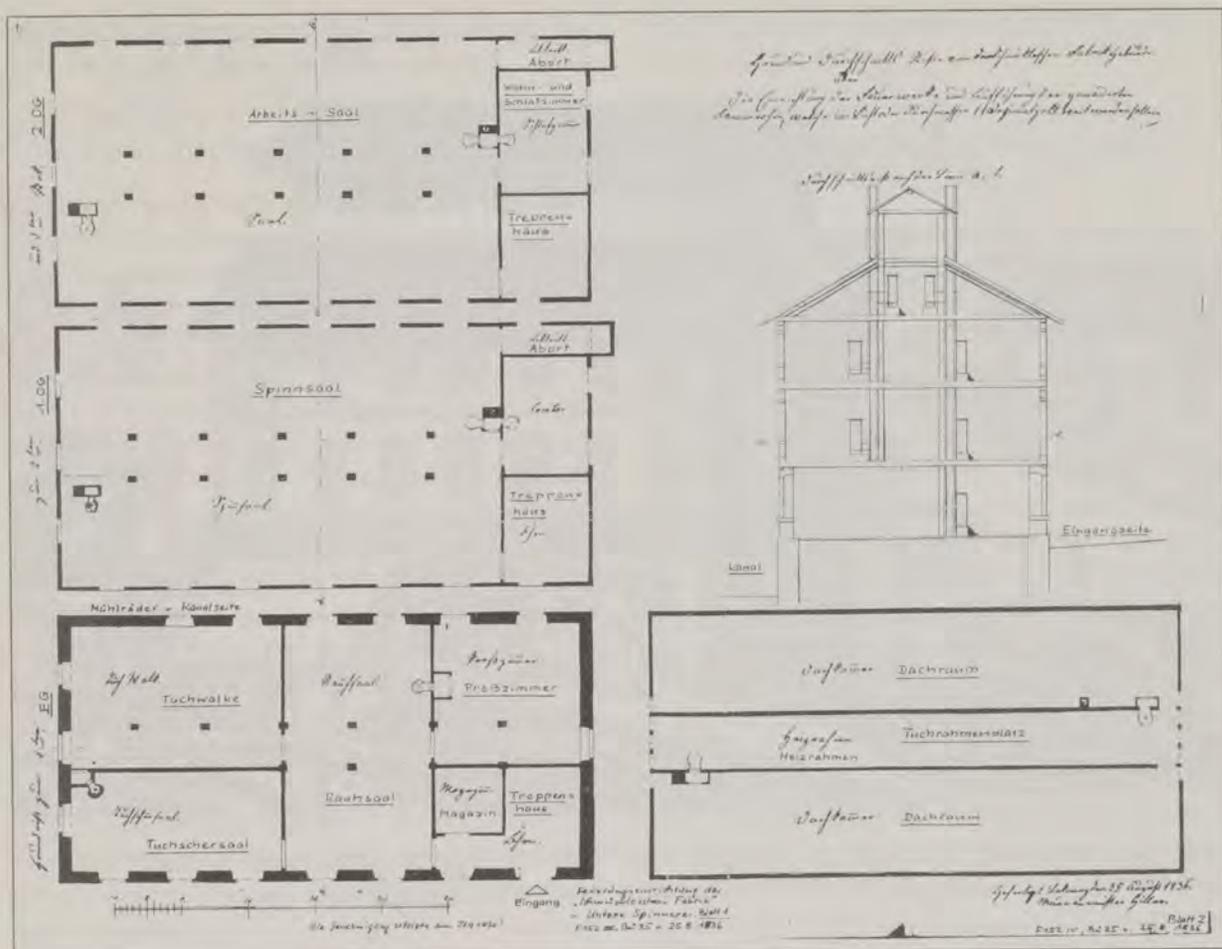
Geschößgrundrisse und Schnitt durch das in Bau befindliche Spinnereigebäude als Bauantrag für „die Einrichtung der Feuerwerke (Öfen) und Aufführung der gemauerten Kaminrohre“ vom 25. 8. 1836. (Die Beschreibungen wurden vom Autor transkribiert bzw. ergänzt.)
